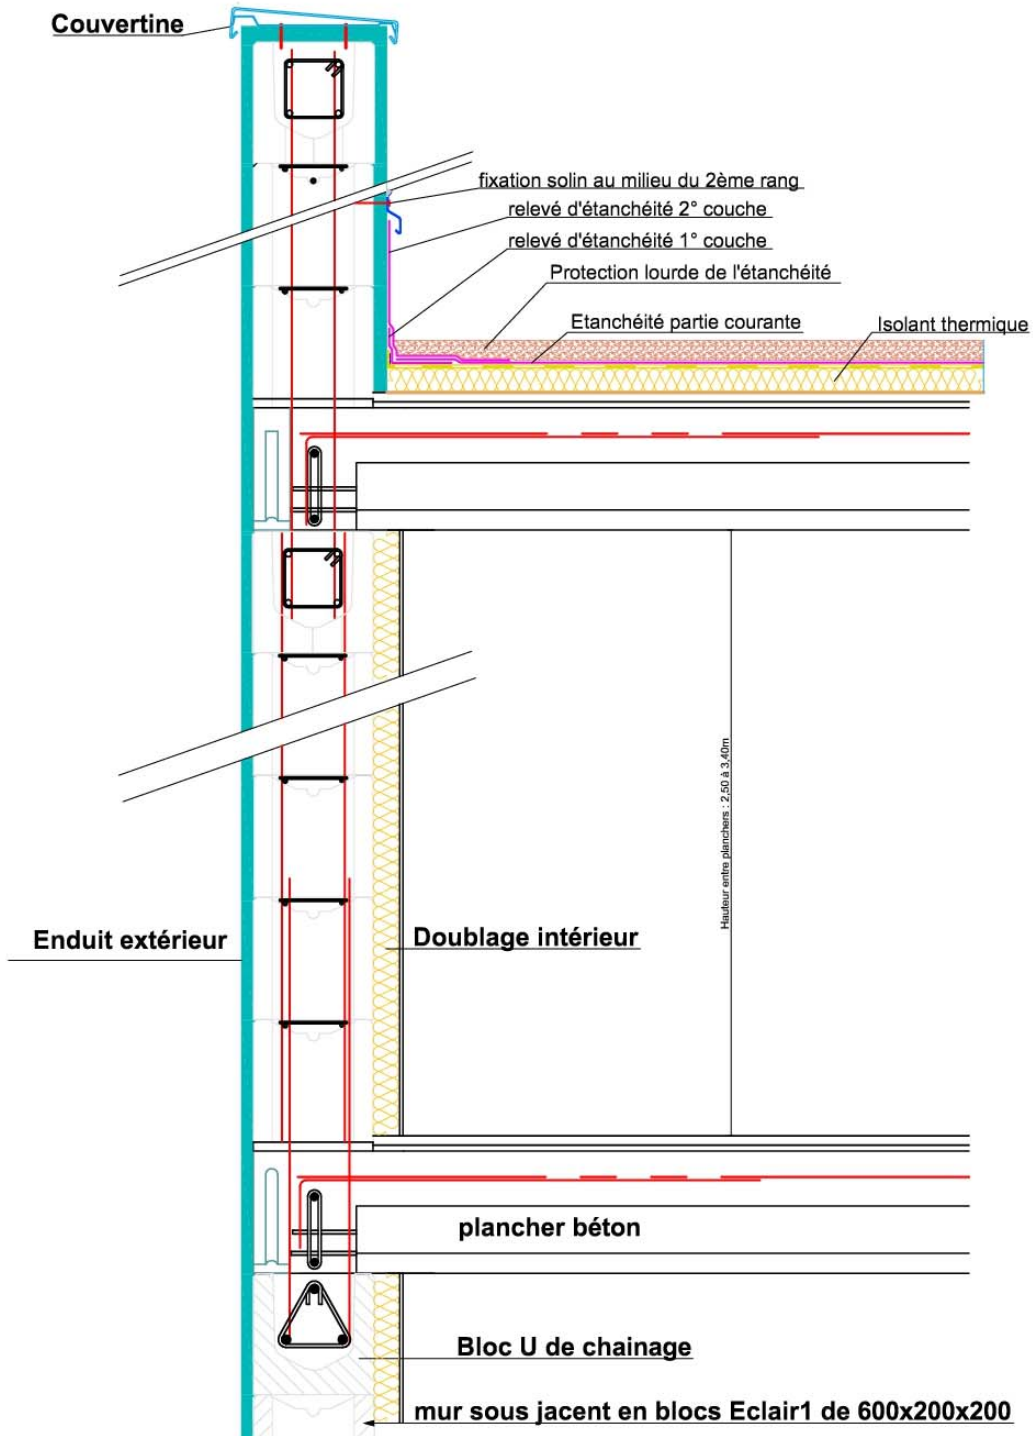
Paroi en béton armé, planchers poutrelles + acrotère en blocs ECLAIR 1
